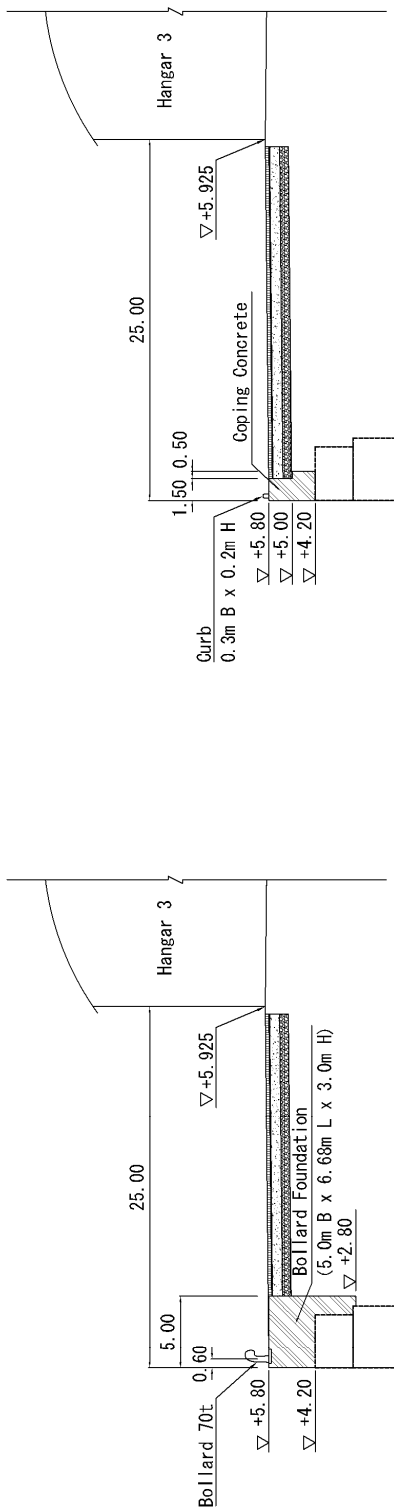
コンテナバースの上部工平面図及び断面図
